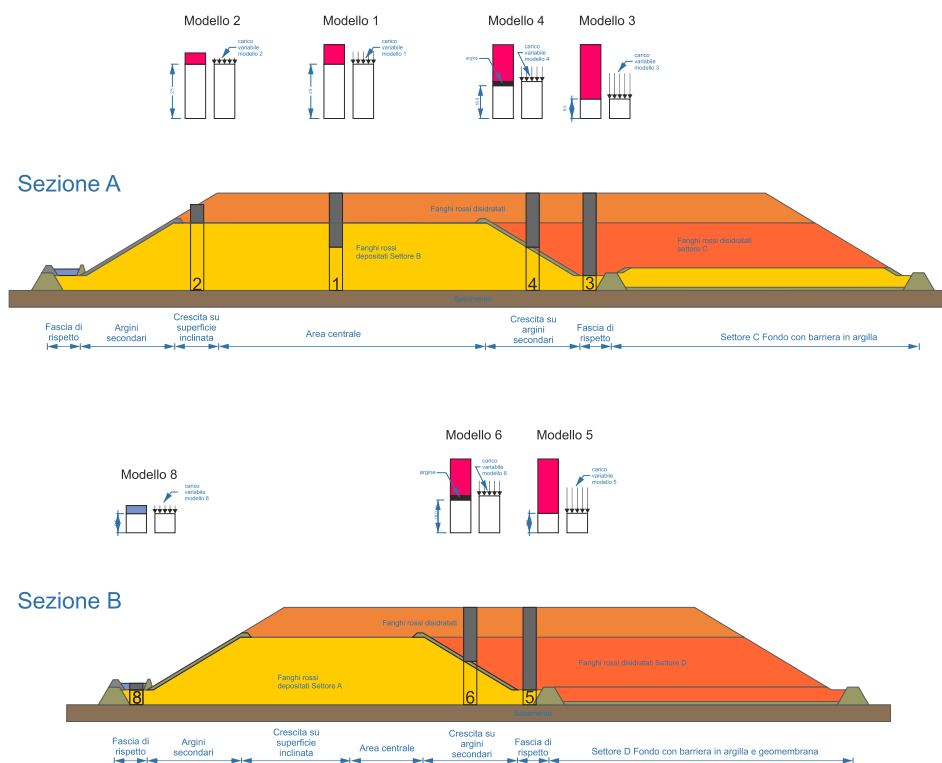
Sezione A (in alto) e sezione B (in basso) del bacino con indicazione dei modelli di calcolo
